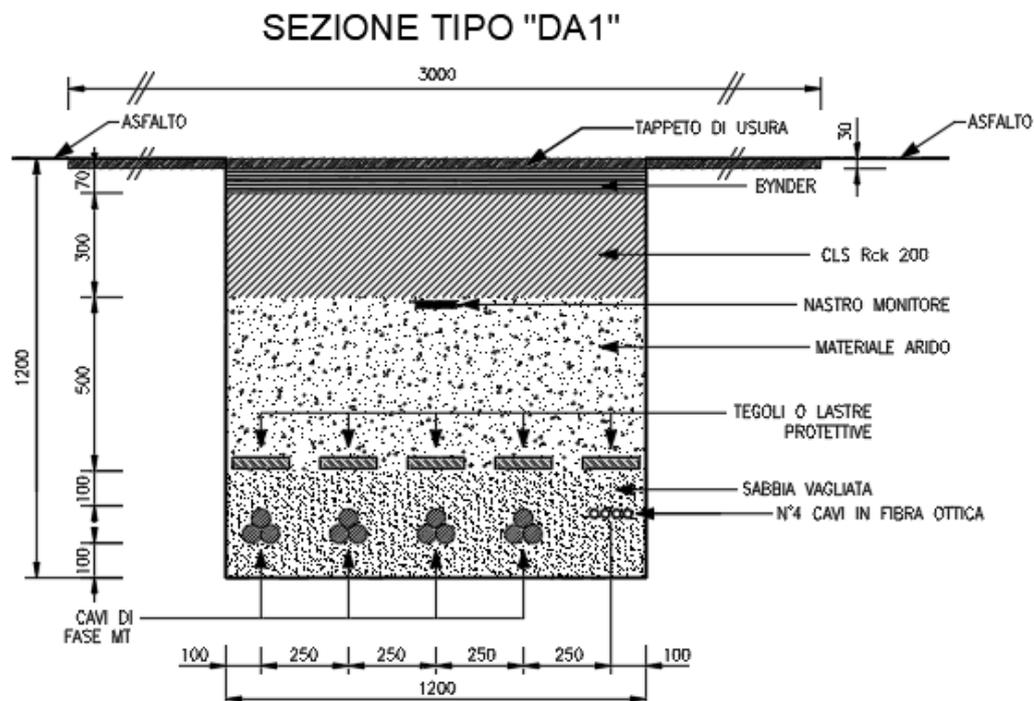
Sezione tipo DA1 estratta dal progetto per posa su strade asfaltate
